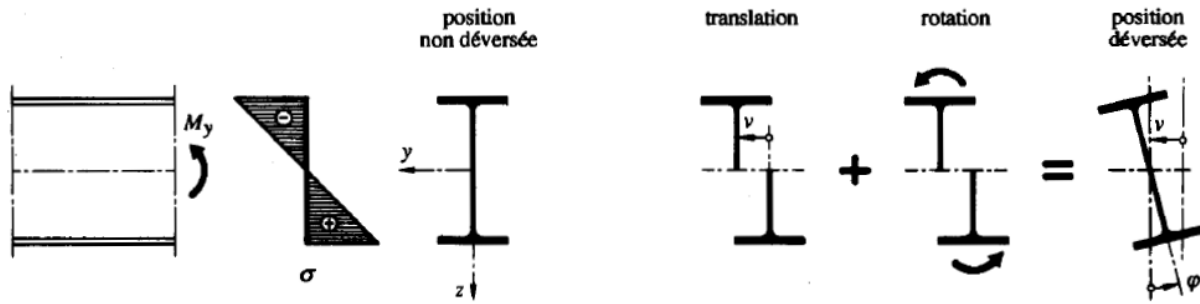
Translation et rotation d'une section d'un élément de poutre sujet au déversement
